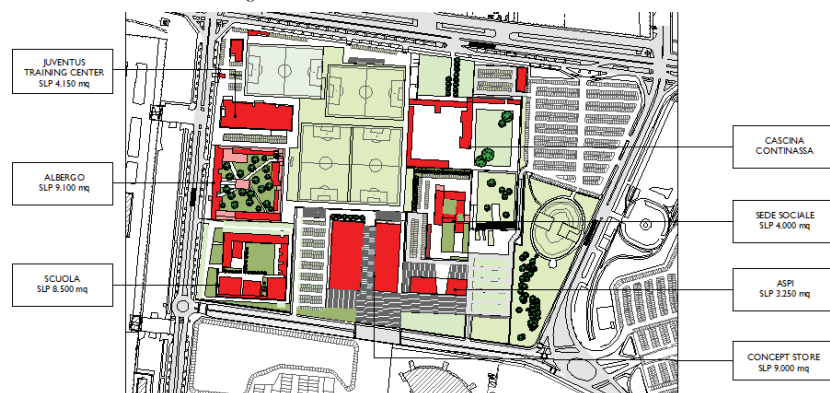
Stralcio del Planivolumetrico - aggiornamento PEC
